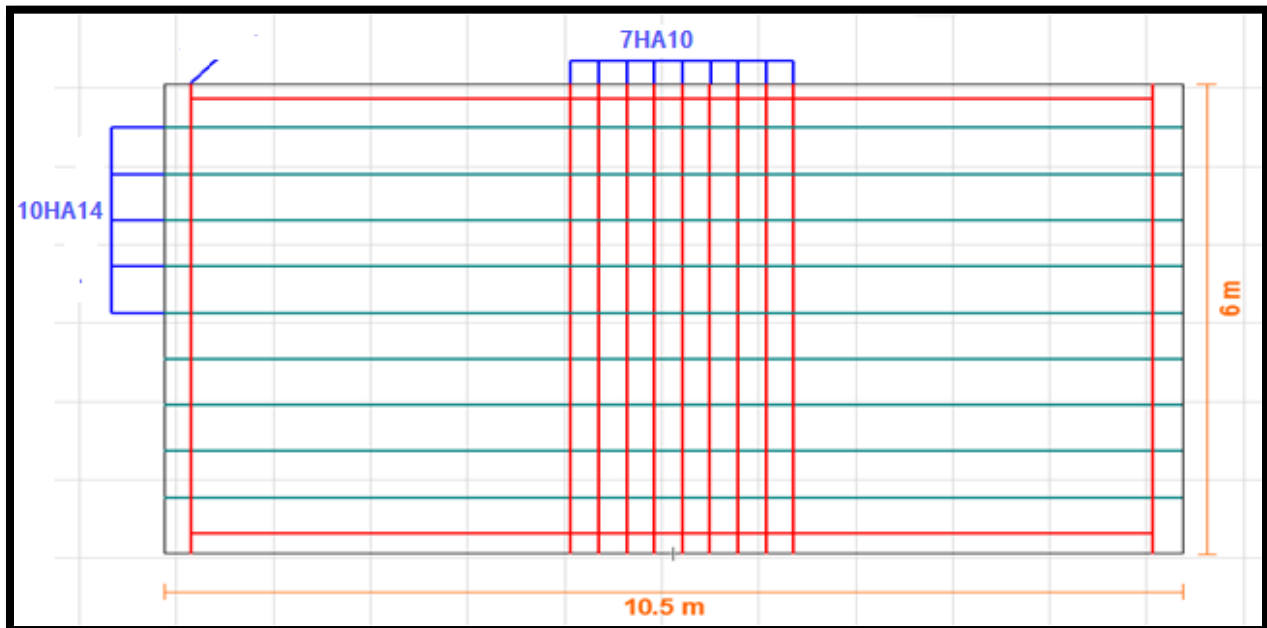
Ferrailage de la semelle – nappe supérieure
